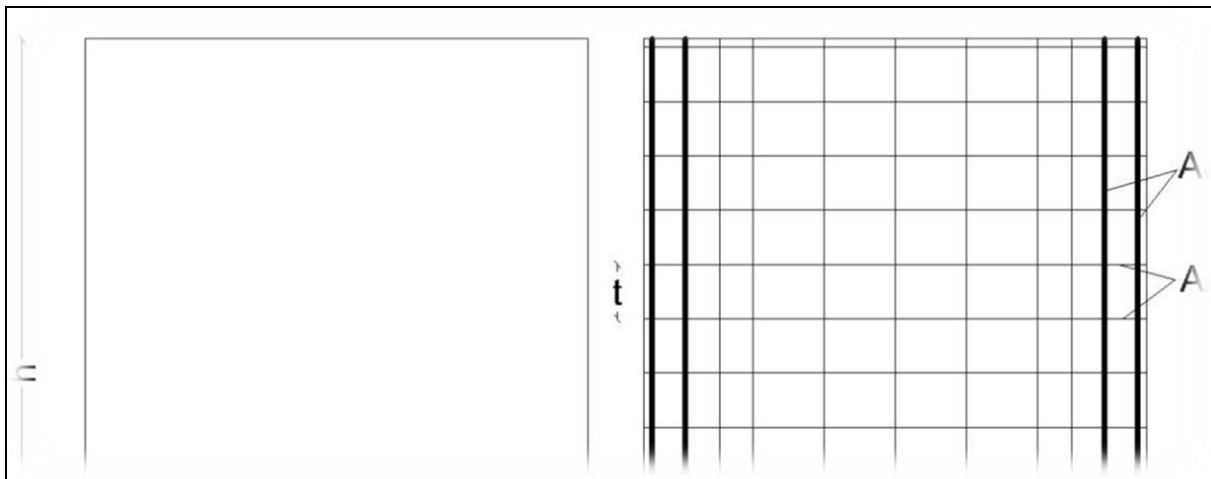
16 : Schéma d'un voile plein et disposition du ferrailage.
